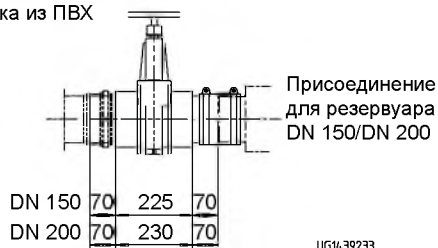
Присоединения типоразмеров UZ 450, UZ 900
